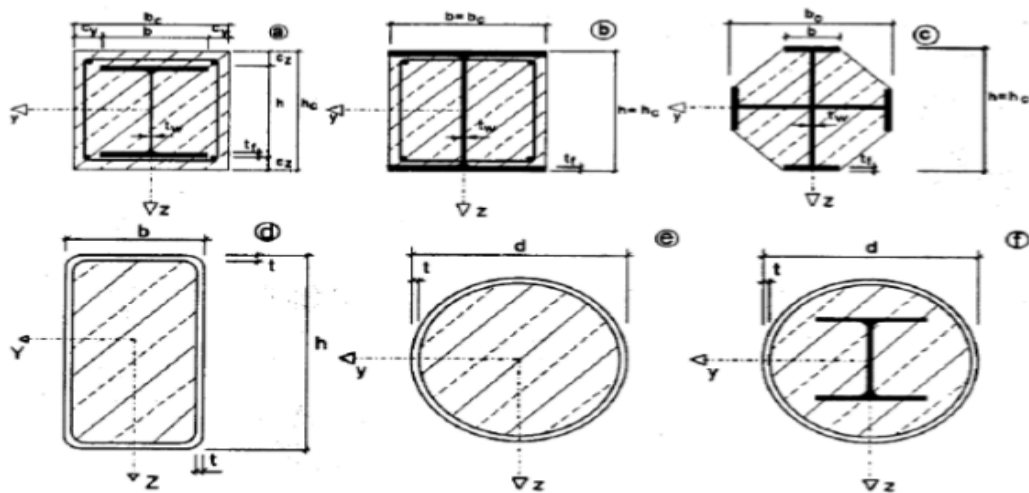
Exemple des types de section transversale des poteaux mixtes. [15]
